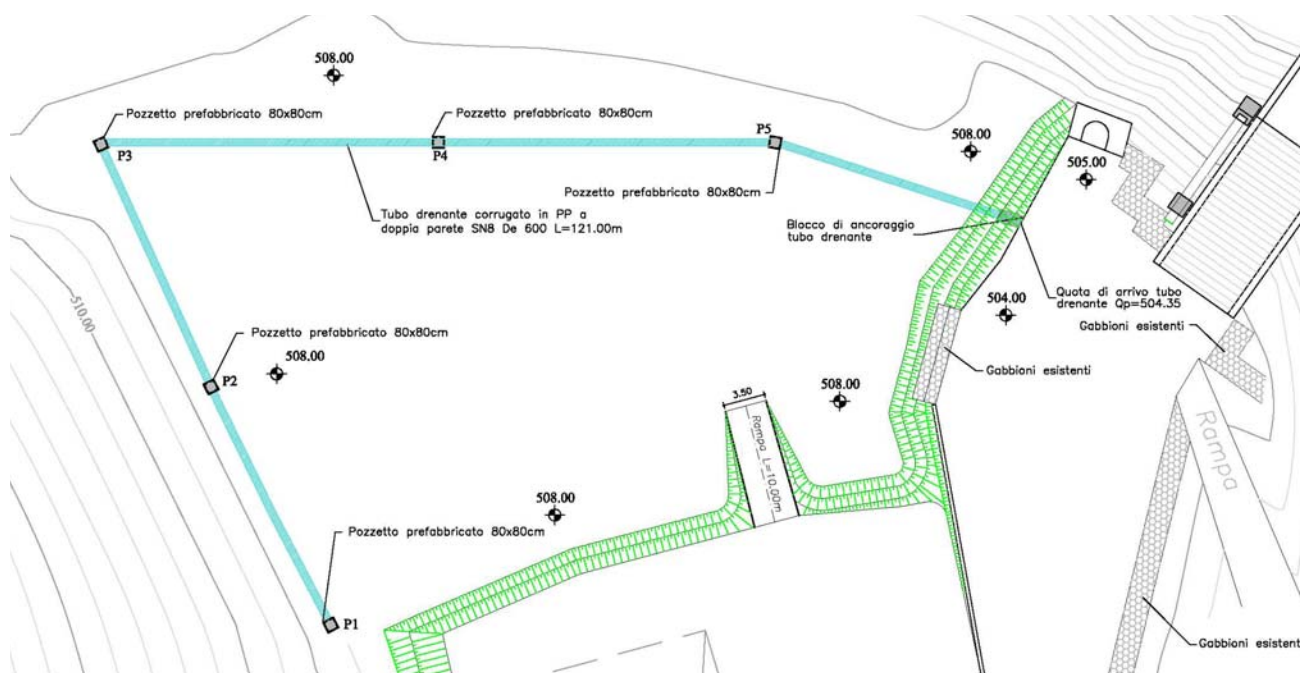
Planimetria drenaggio a valle dello sbarramento
